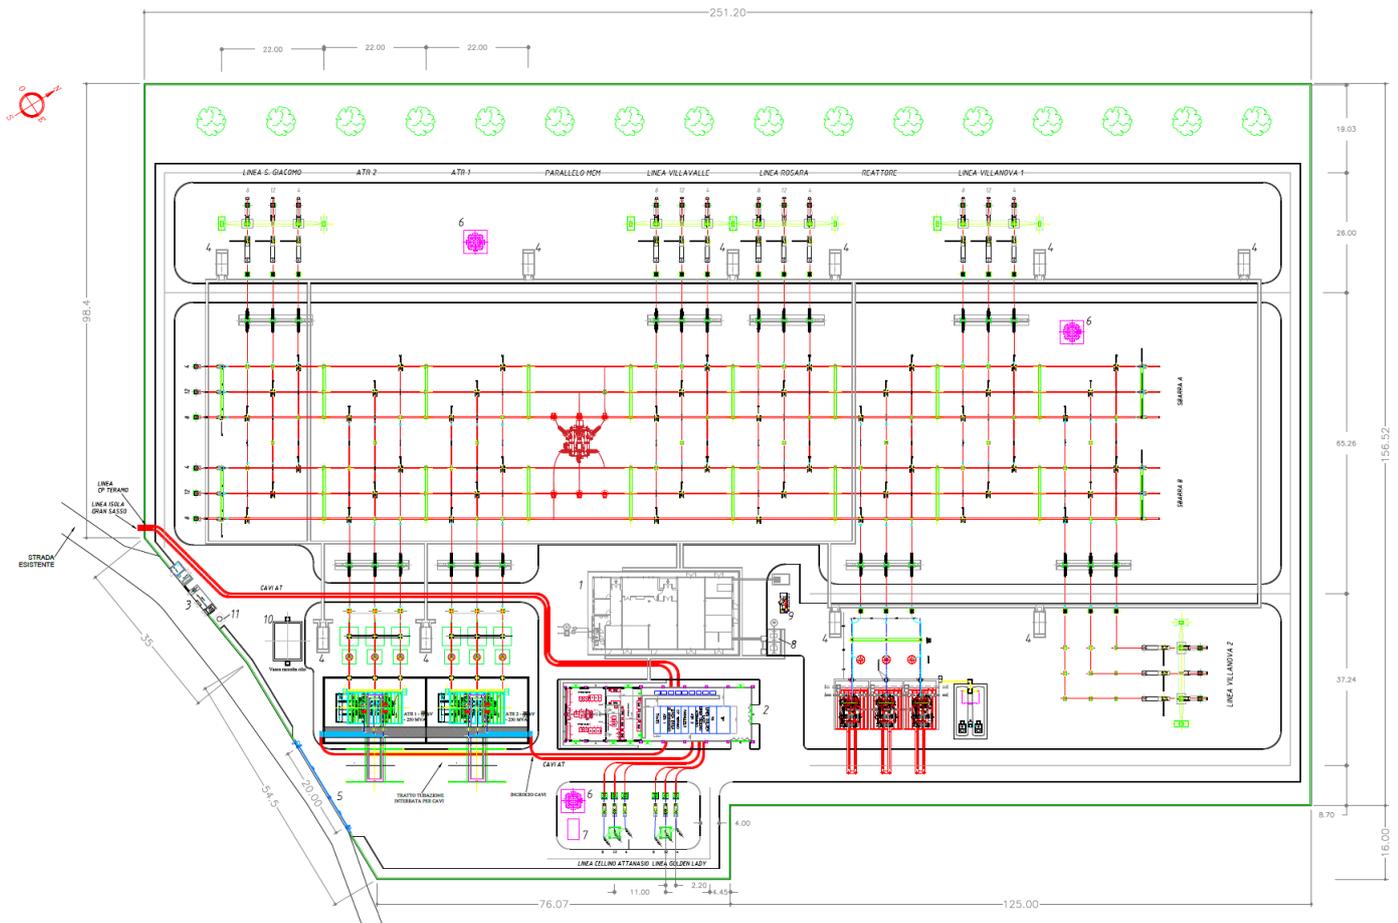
Planimetria elettromeccanica generale futuro impianto
